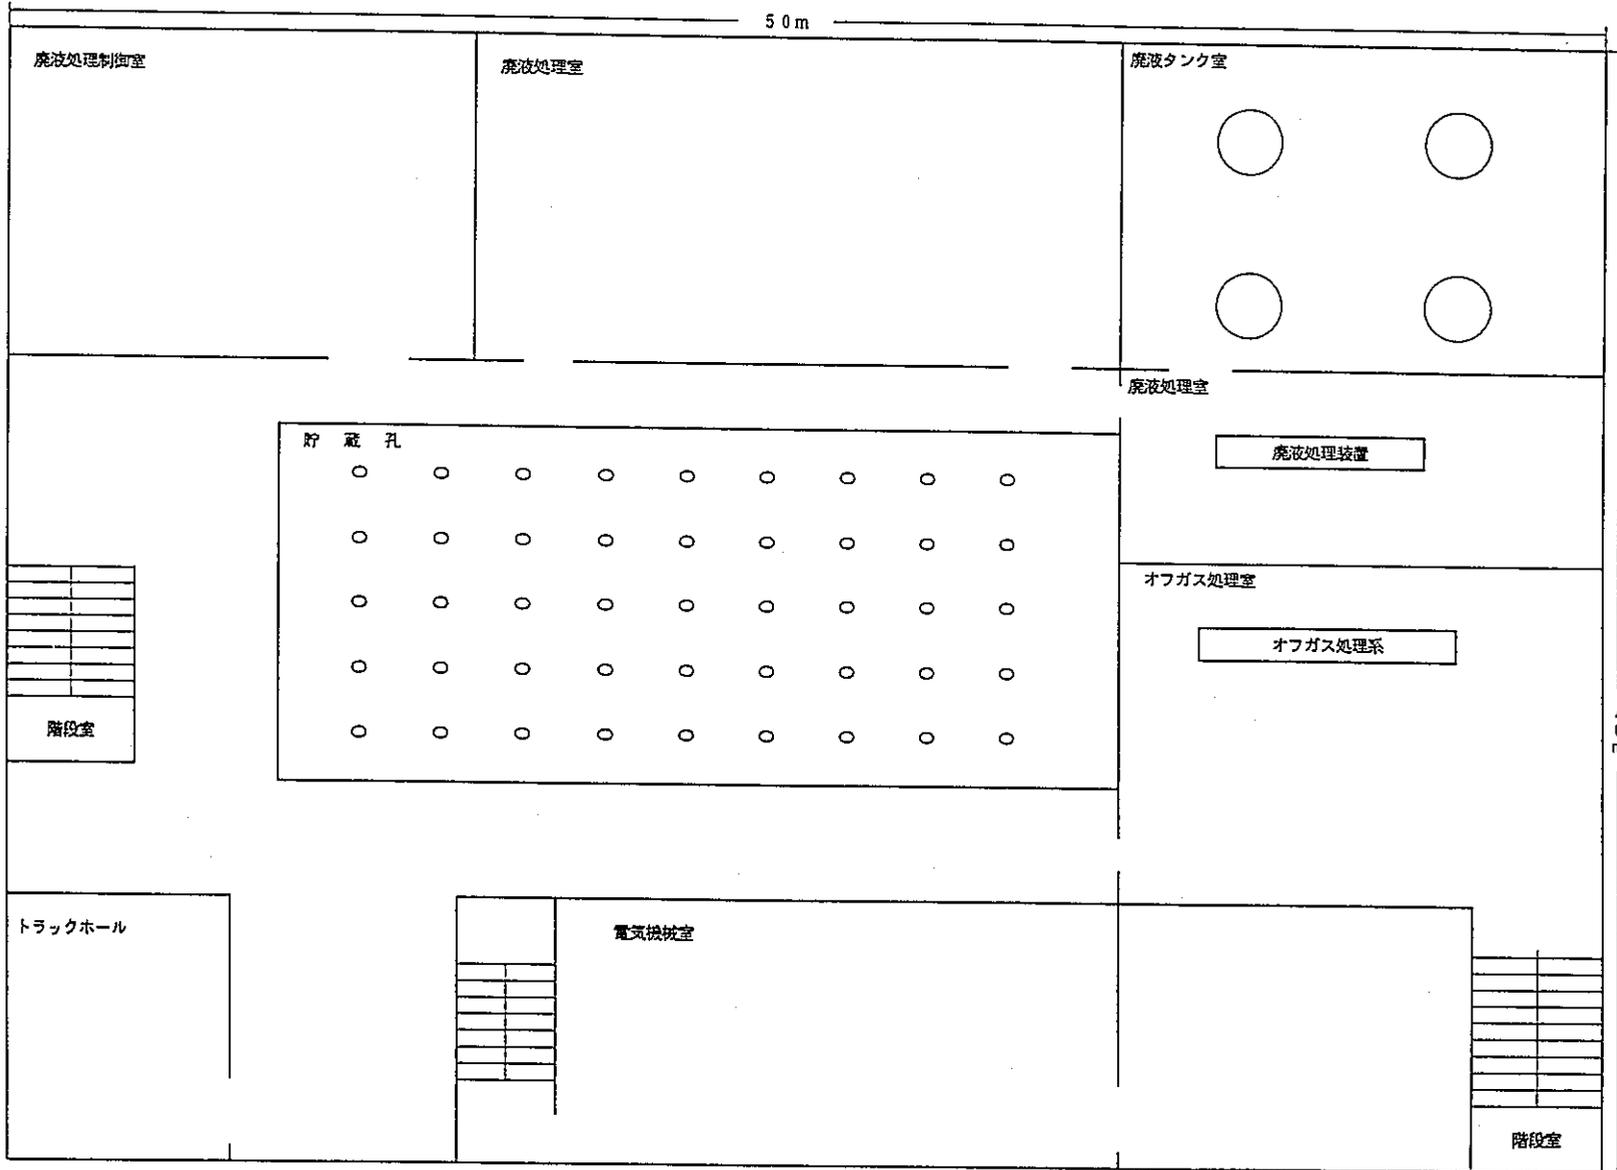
高砂市立α固体廃棄物処理場浄化施設(地階)平面図(1/4)
